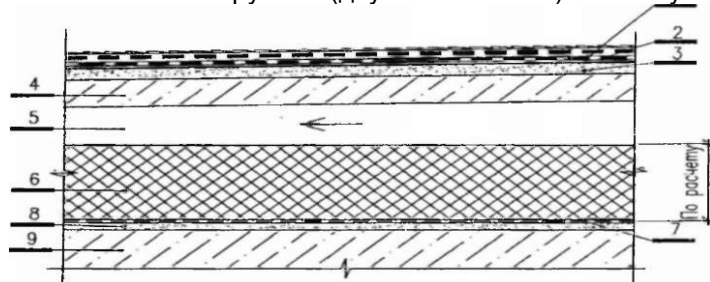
Вентилируемая (двухоболочковая) неэксплуатируемая кровля
